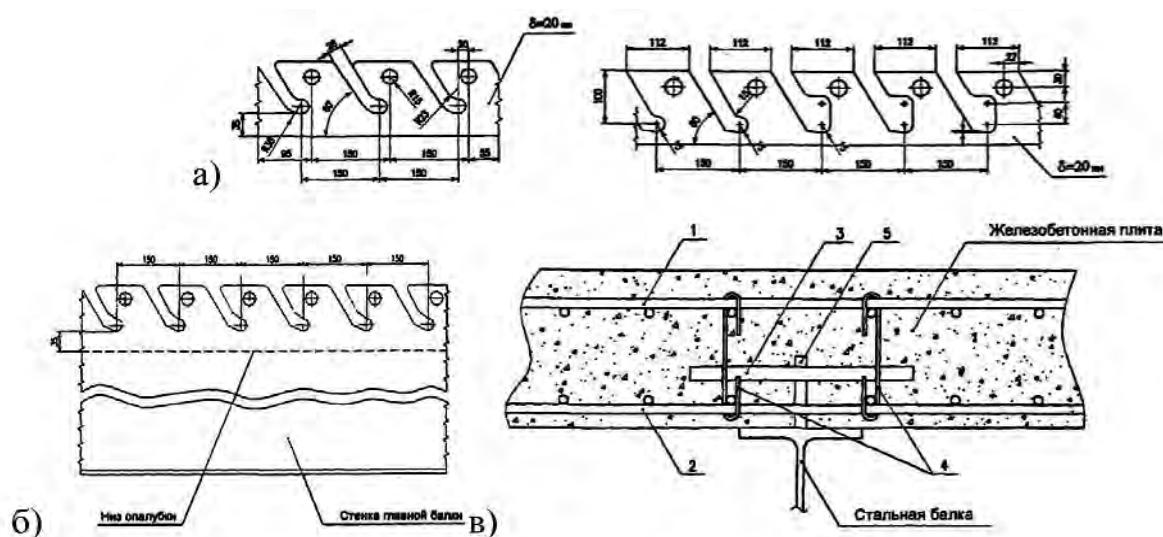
Конструкция объединения бетона и стали [8]: а) гребенчатая полоса; б) гребенка в стенке балки; в) конструкция стыка: 1 – верхняя сетка арматуры; 2 – нижняя сетка арматуры; 3 – анкерный стержень; 4 – стяжки; 5 – гребенчатый упор
